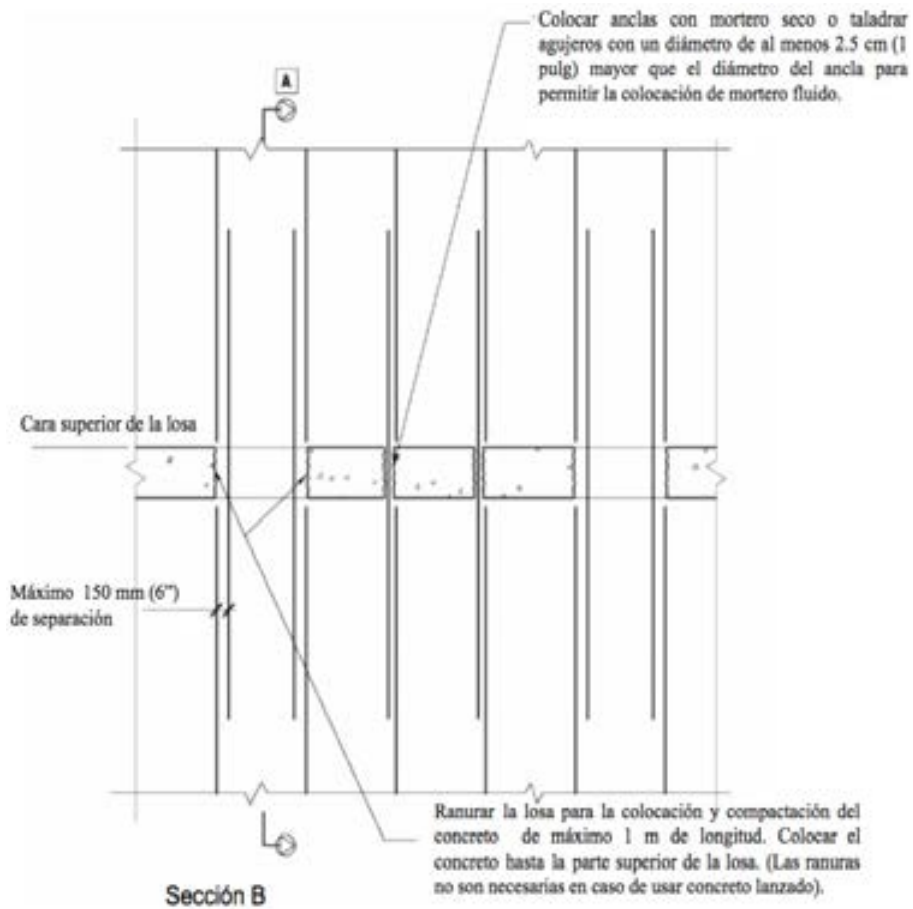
Conexión de un muro en edificios con losas macizas (FEMA 547)
